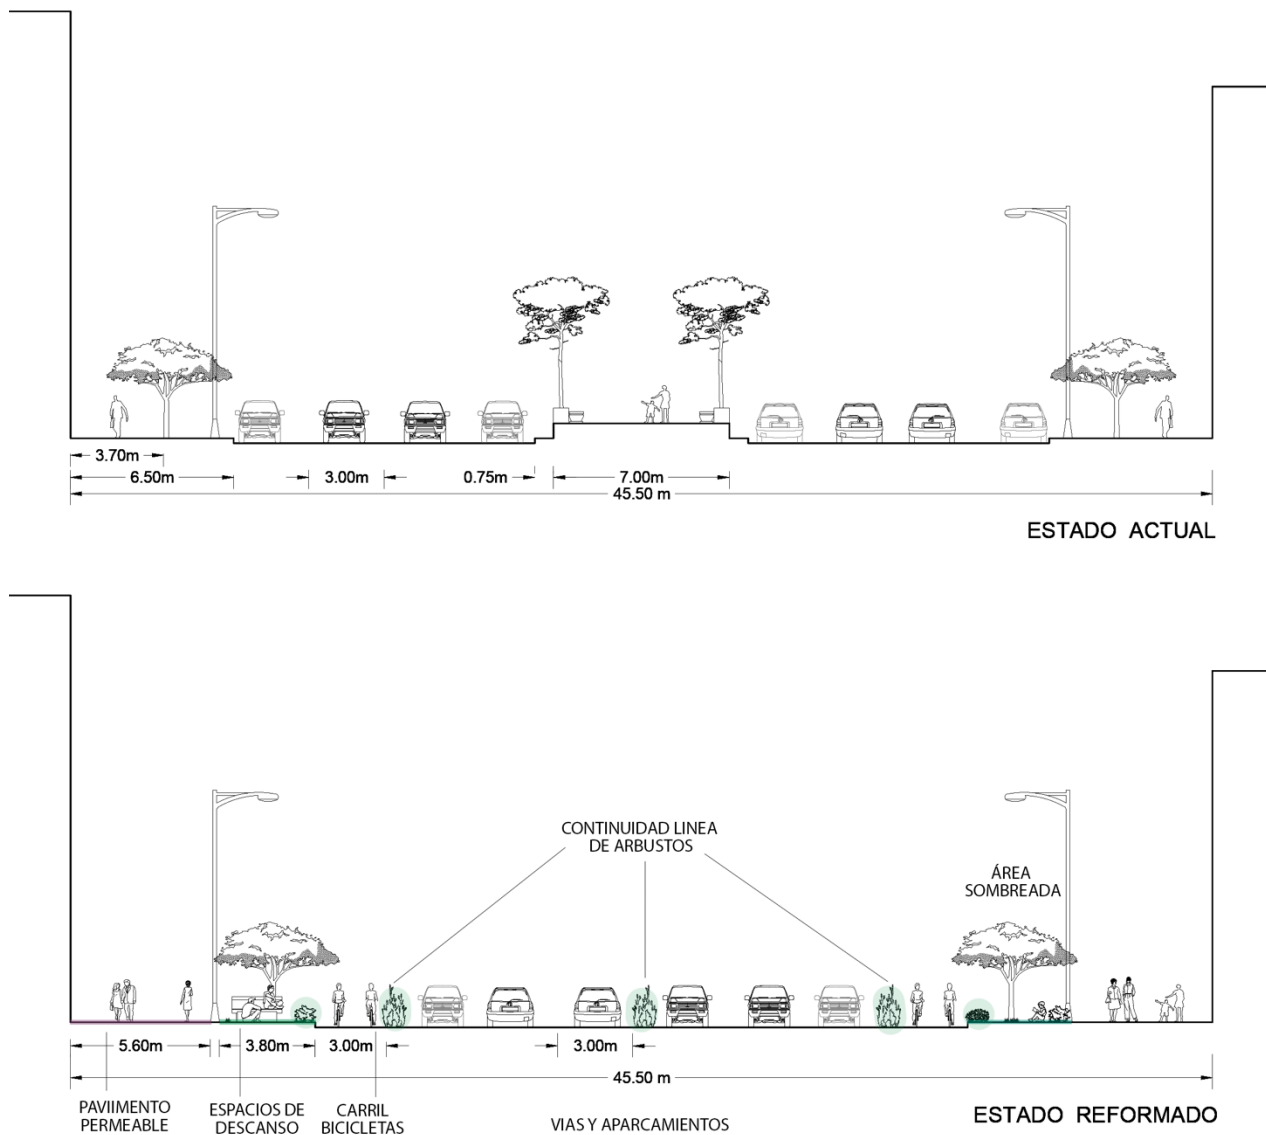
Plano de sección tipo de avenida. Fuente: elaboración propia
